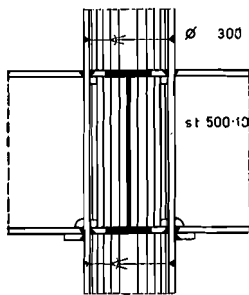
Geschweißter Rahmenknoten mit durchgehender Stütze
